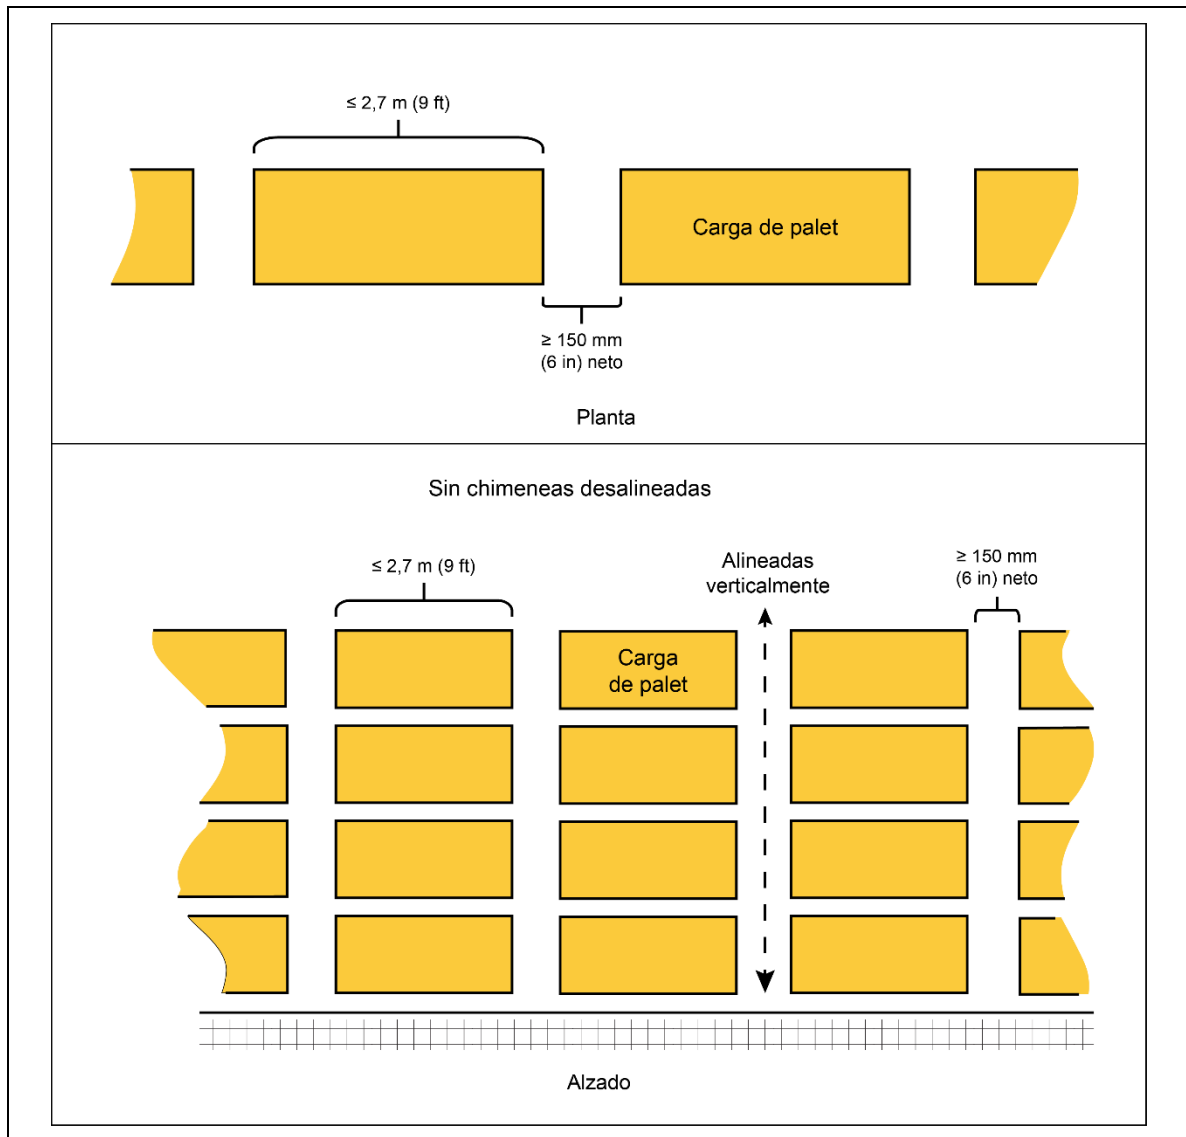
Configuración aceptable de las chimeneas transversales para estanterías simples, Opción 2
